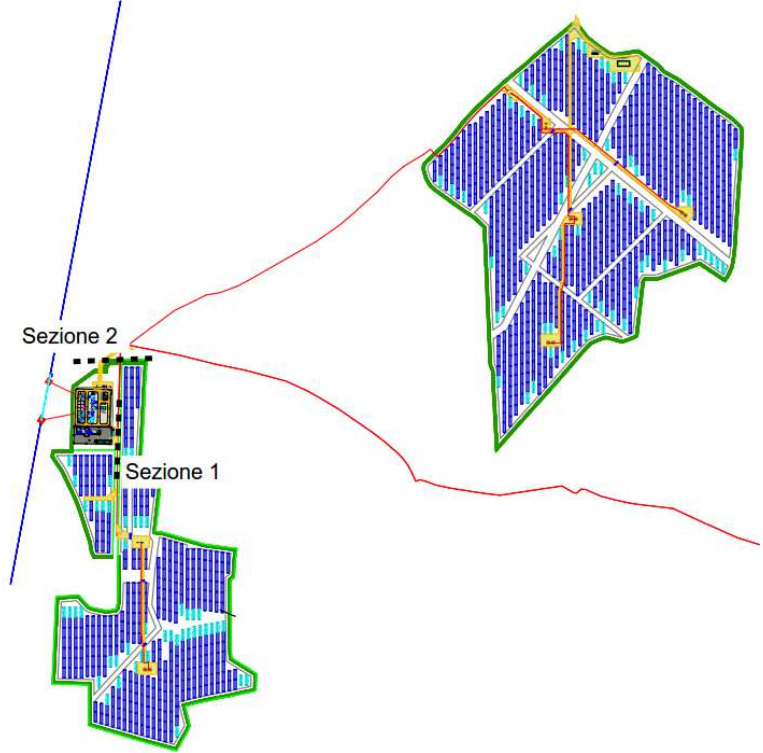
Dettaglio planimetria con le sezioni 1 e 2.
